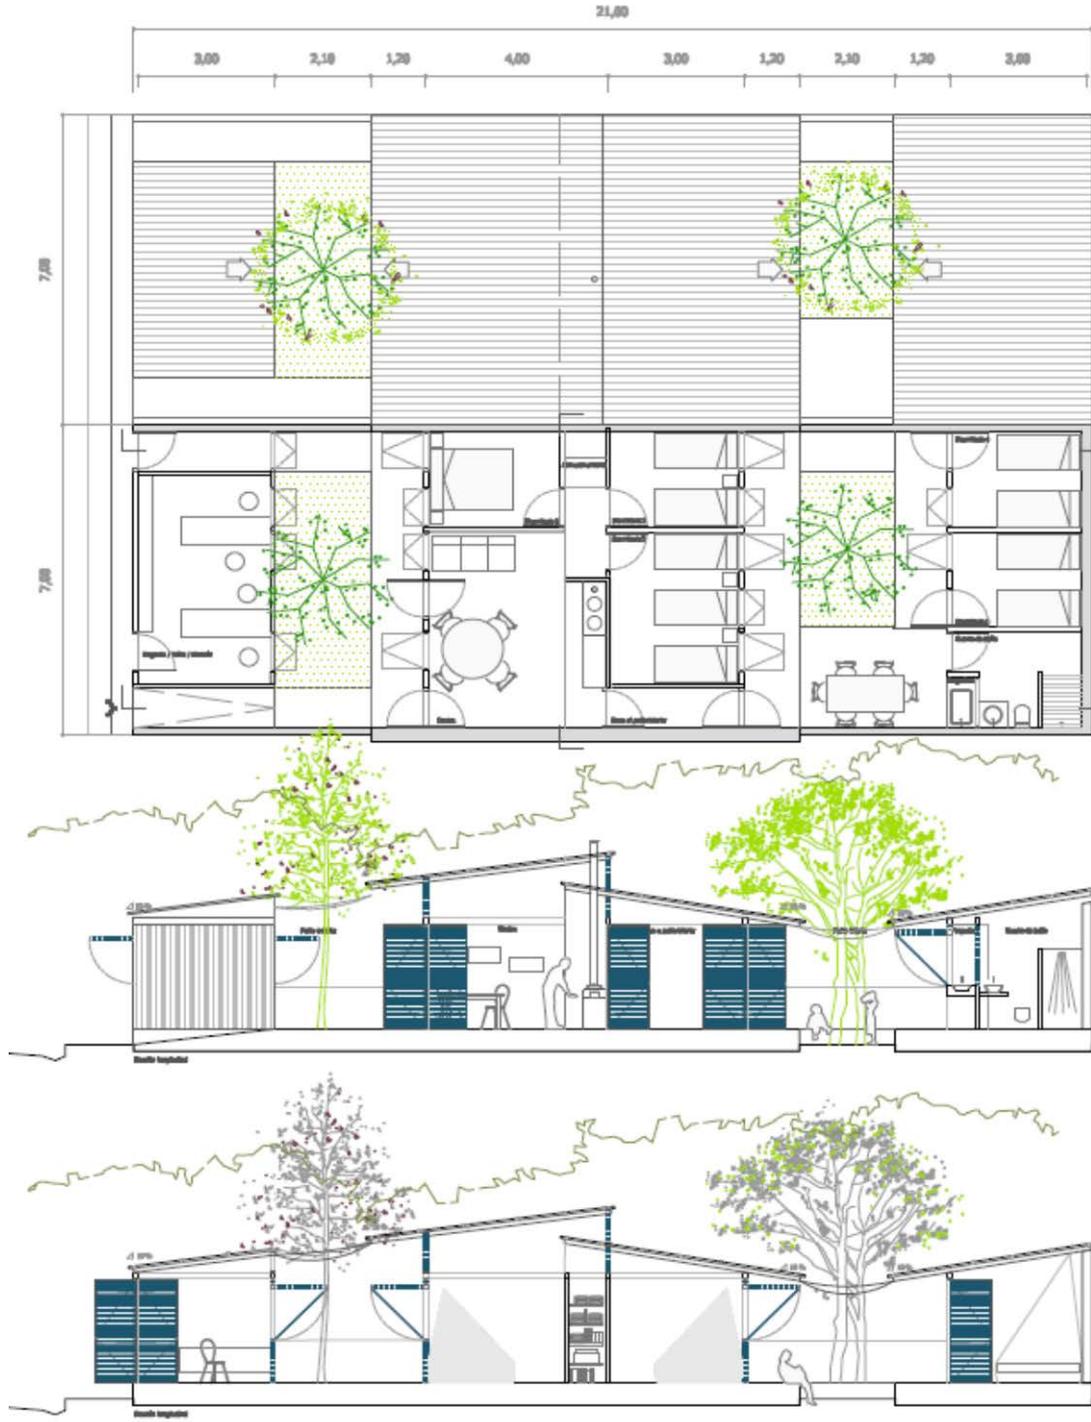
Esquema de la cuarta fase de construcción de la vivienda
